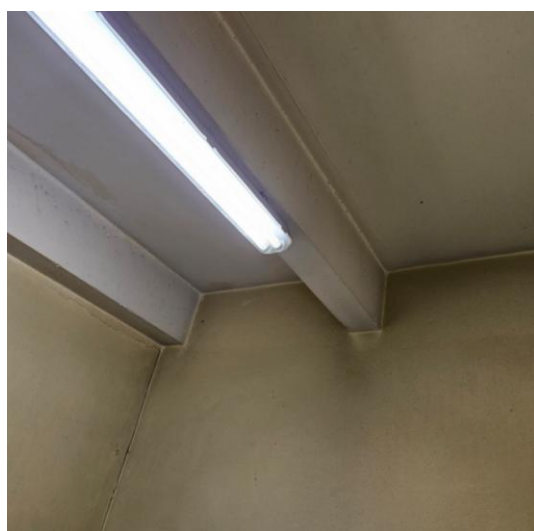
Liaison poutre / mur Est de la cage d'ascenseur (niveau R-1)
